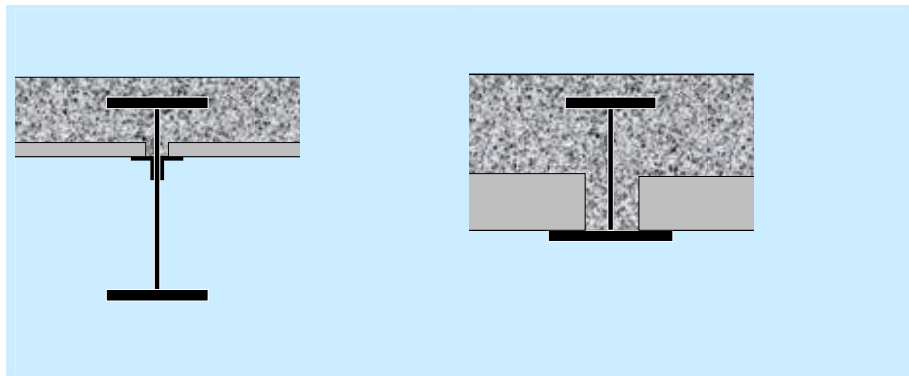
Vigas integradas en un forjado tipo “Slim Floor”
